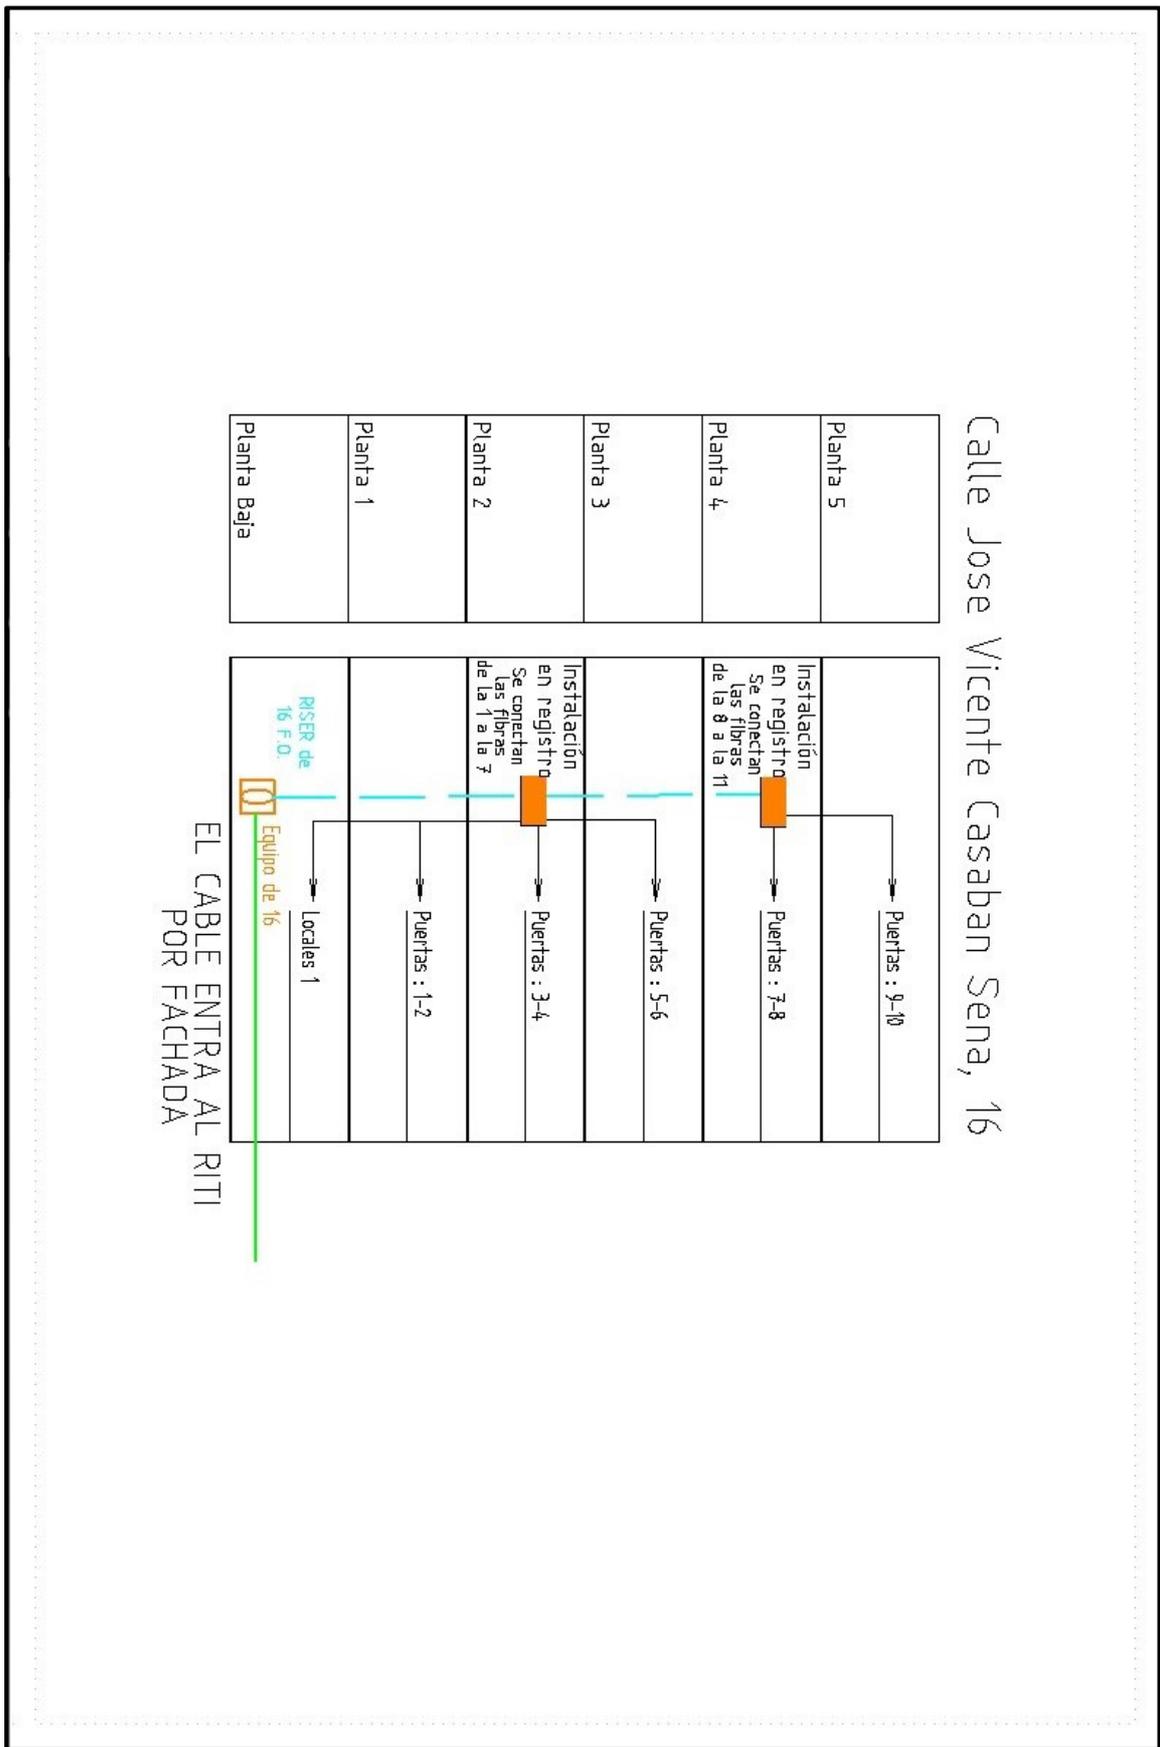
Plano Jose Vicente Casaban Sena, 16
